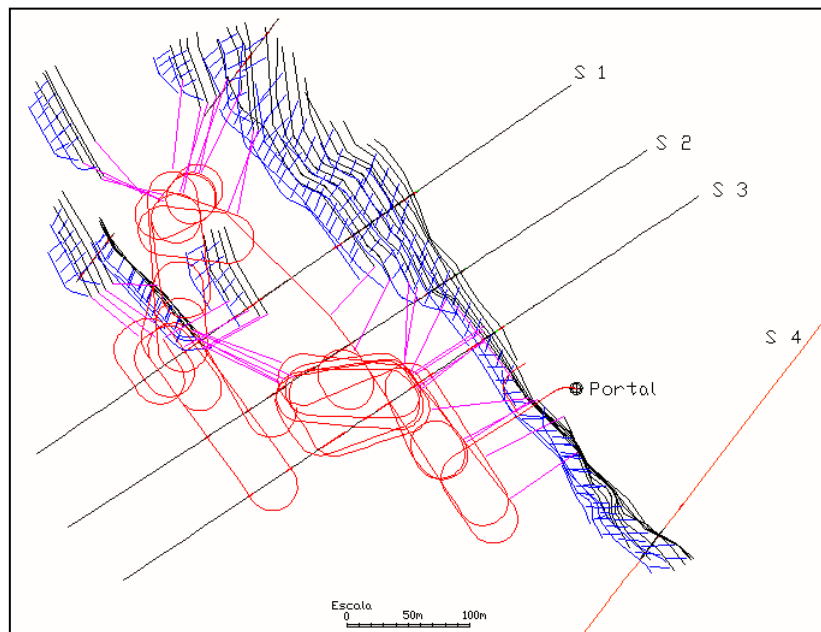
Planta com indicação das seções utilizadas para a análise geomecânica, juntamente com as aberturas planejadas para o desenvolvimento da mina.
